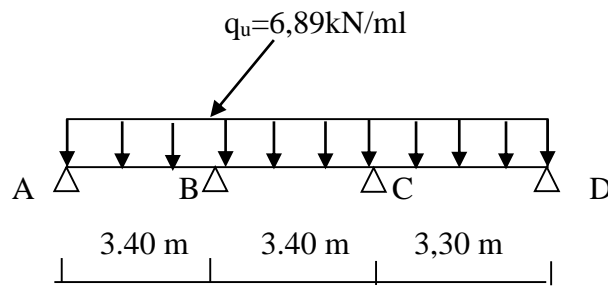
Schéma statique de la poutrelle sur 4 appuis.
